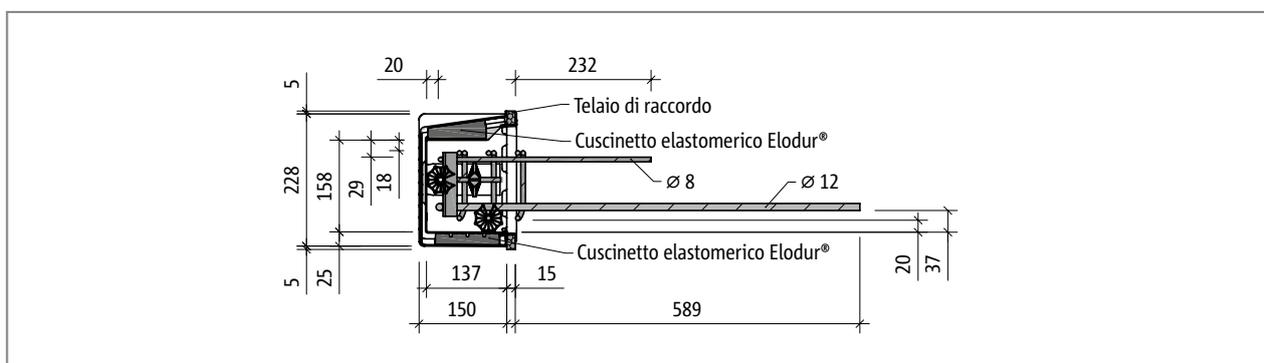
Schöck Tronsole® tipo Z-V+V-T e tipo Z-VH+VH-T, sezione verticale
